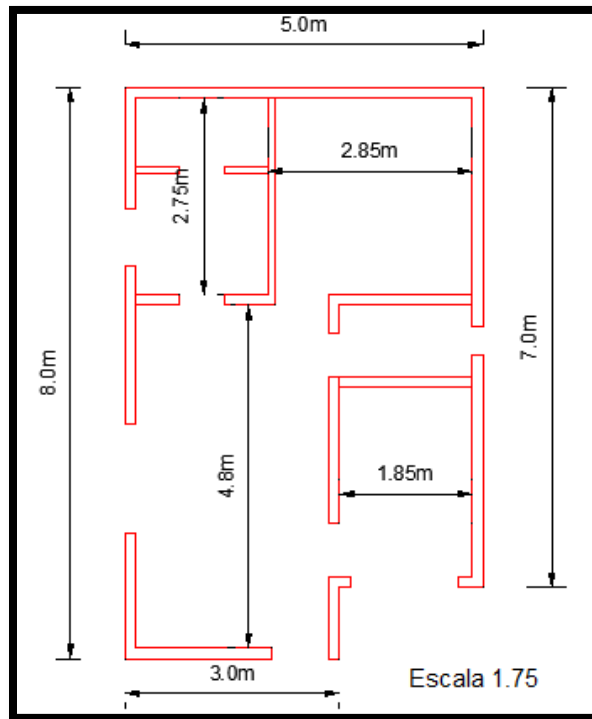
Plano en planta Un Techo Para Todos C.I.U
